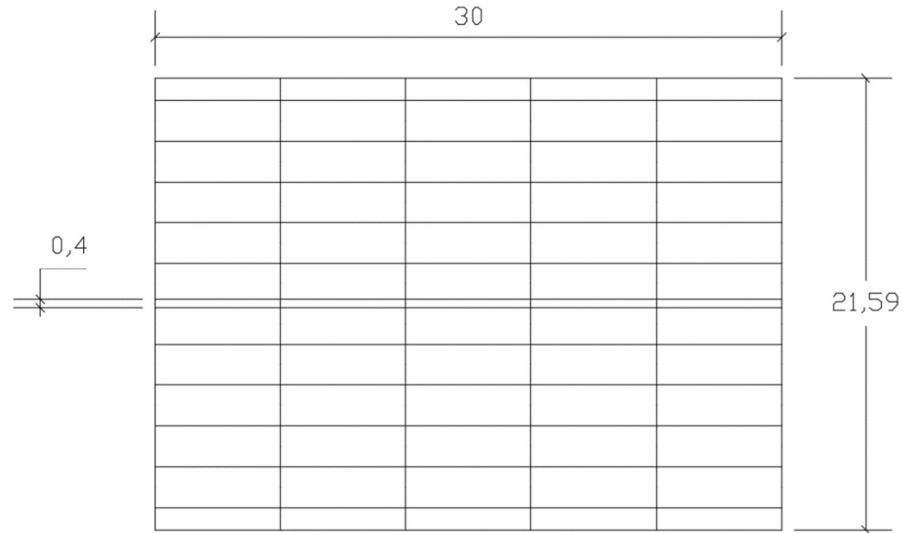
Vista en planta de la cubierta con dimensiones generales
